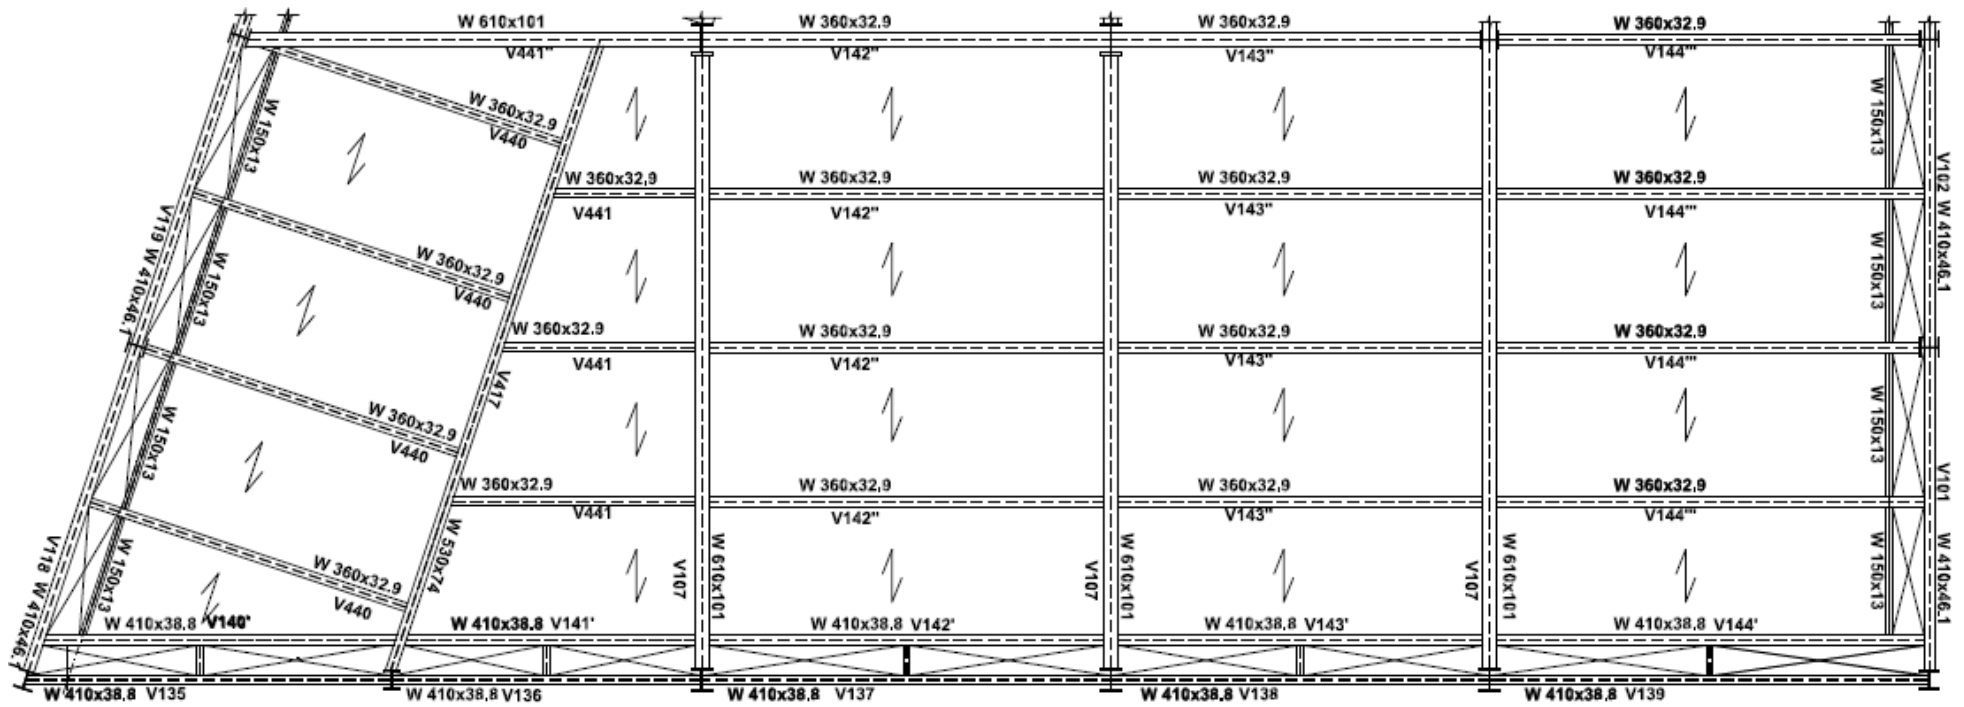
Plano das vigas do segundo pavimento (EL. +5850) do Edifício das Licenciaturas.
